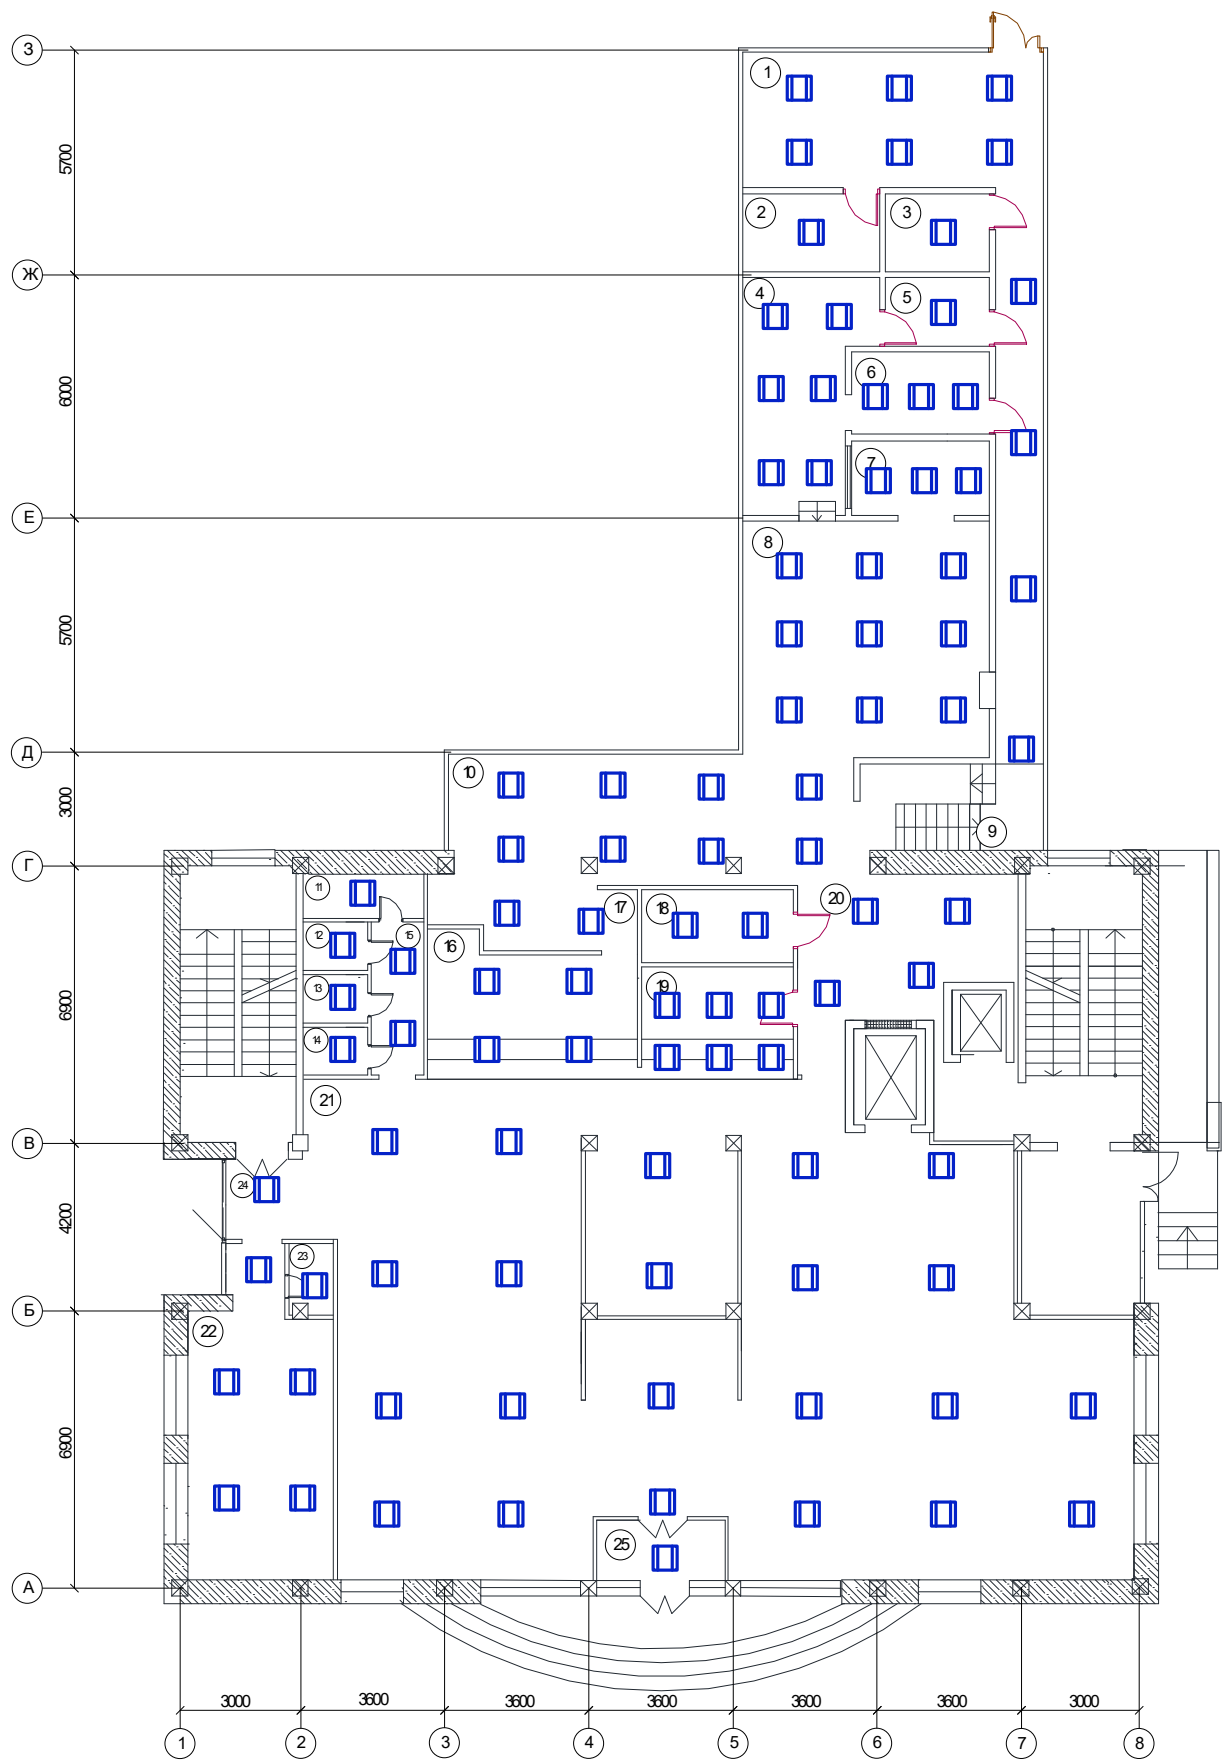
Схема размещения светильников на плане здания ресторана
